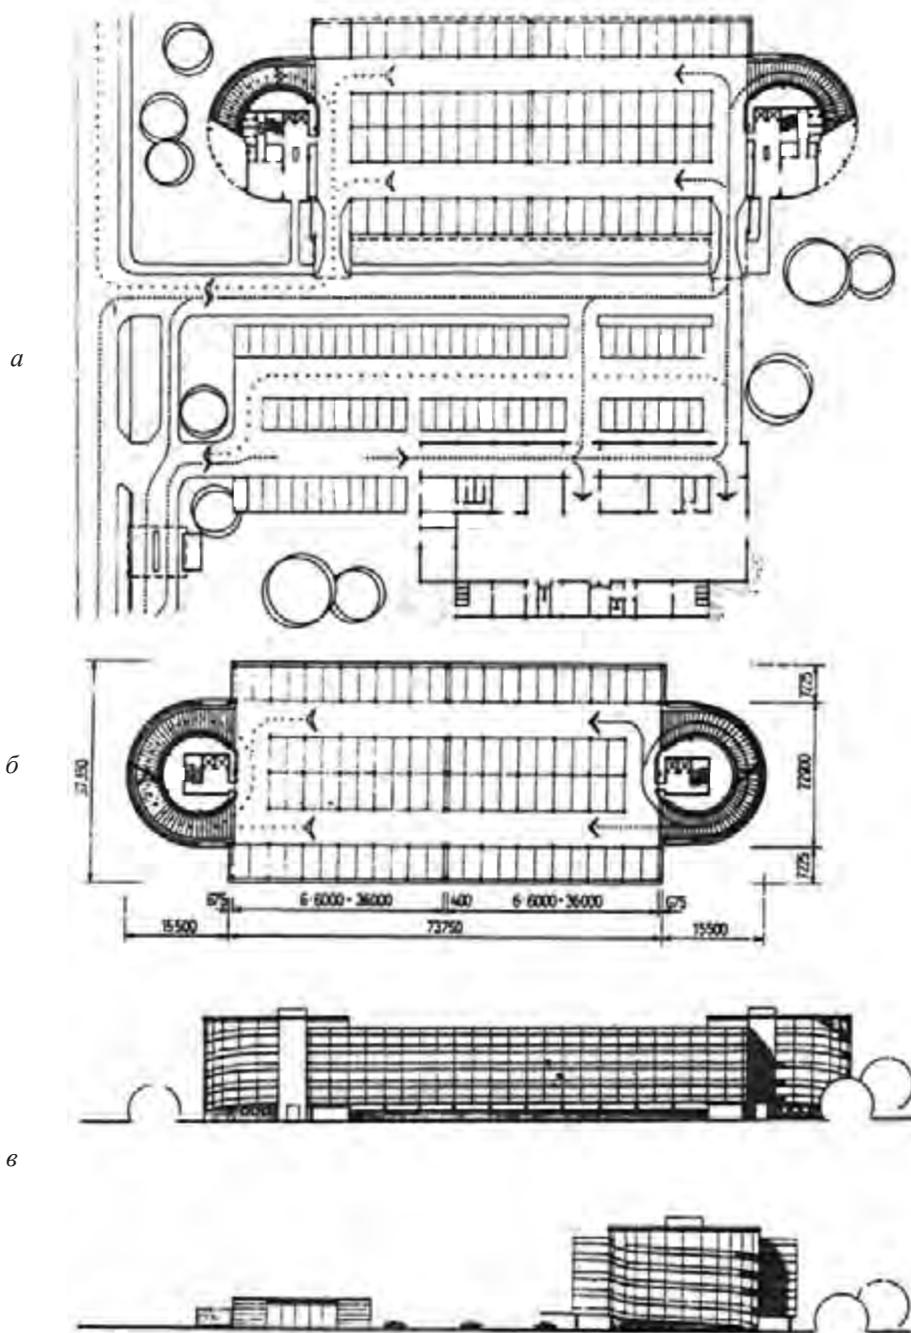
Пристроенные криволинейные однопутные рампы (одна — на въезд, другая — на выезд). Парковка рамповая 6000 × 6000 мм; площадь — 3355 м²; вместимость — 544 автомобиля; площадь на 1 автомобиль — 6,52 м²; а — план на уровне земли; б — план типового этажа; в — фасады
